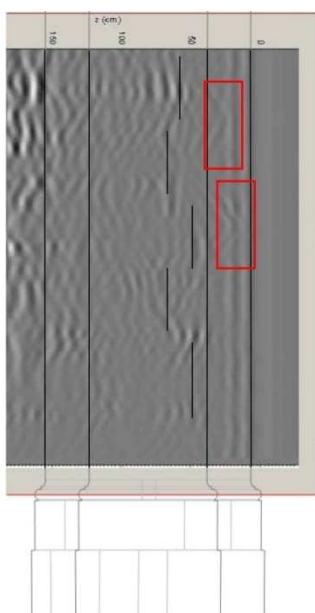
Esempio di sovrapposizione della geometria del pilastro e un profilo radar.
